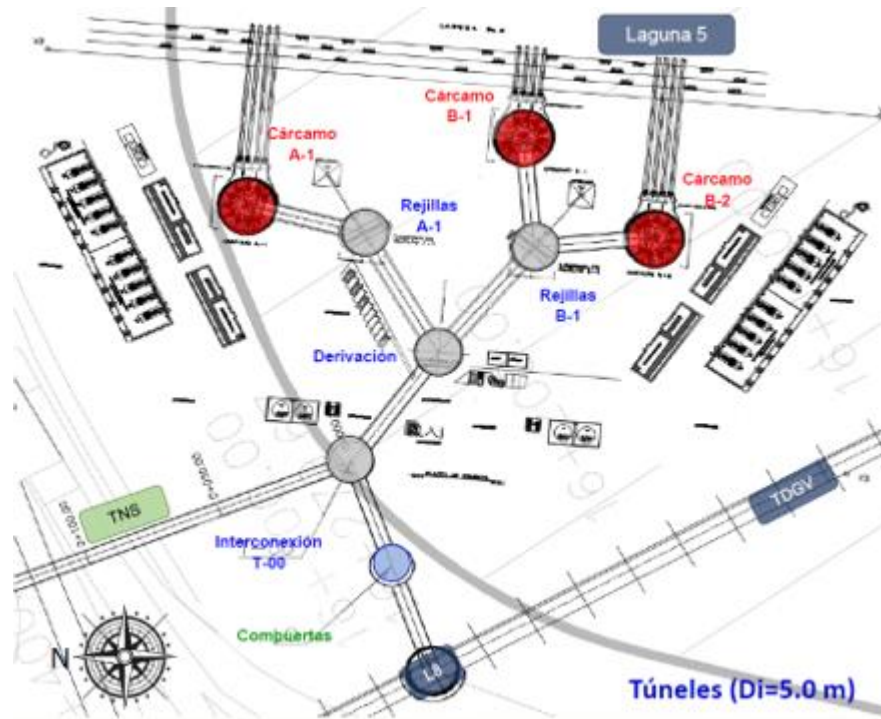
Arreglo General de Estructuras de interconexión del Drenaje Pluvial Profundo.
